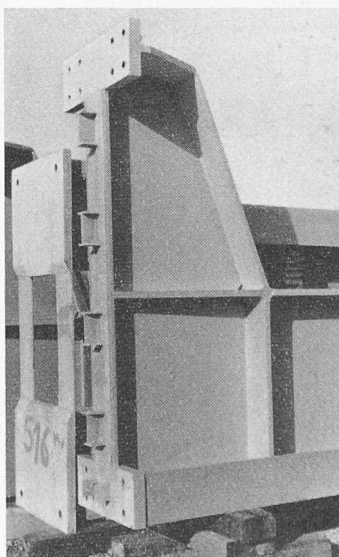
Kopf einer Stütze der 36-m-Halle, links daneben Fussplatte des Stützenfusses
